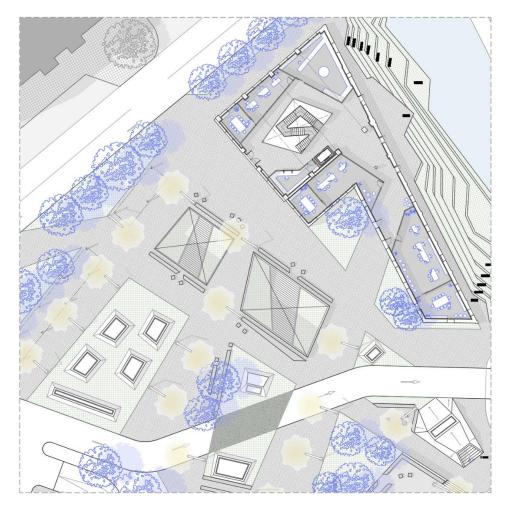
Planta baja. Fuente: Elaboración propia.
